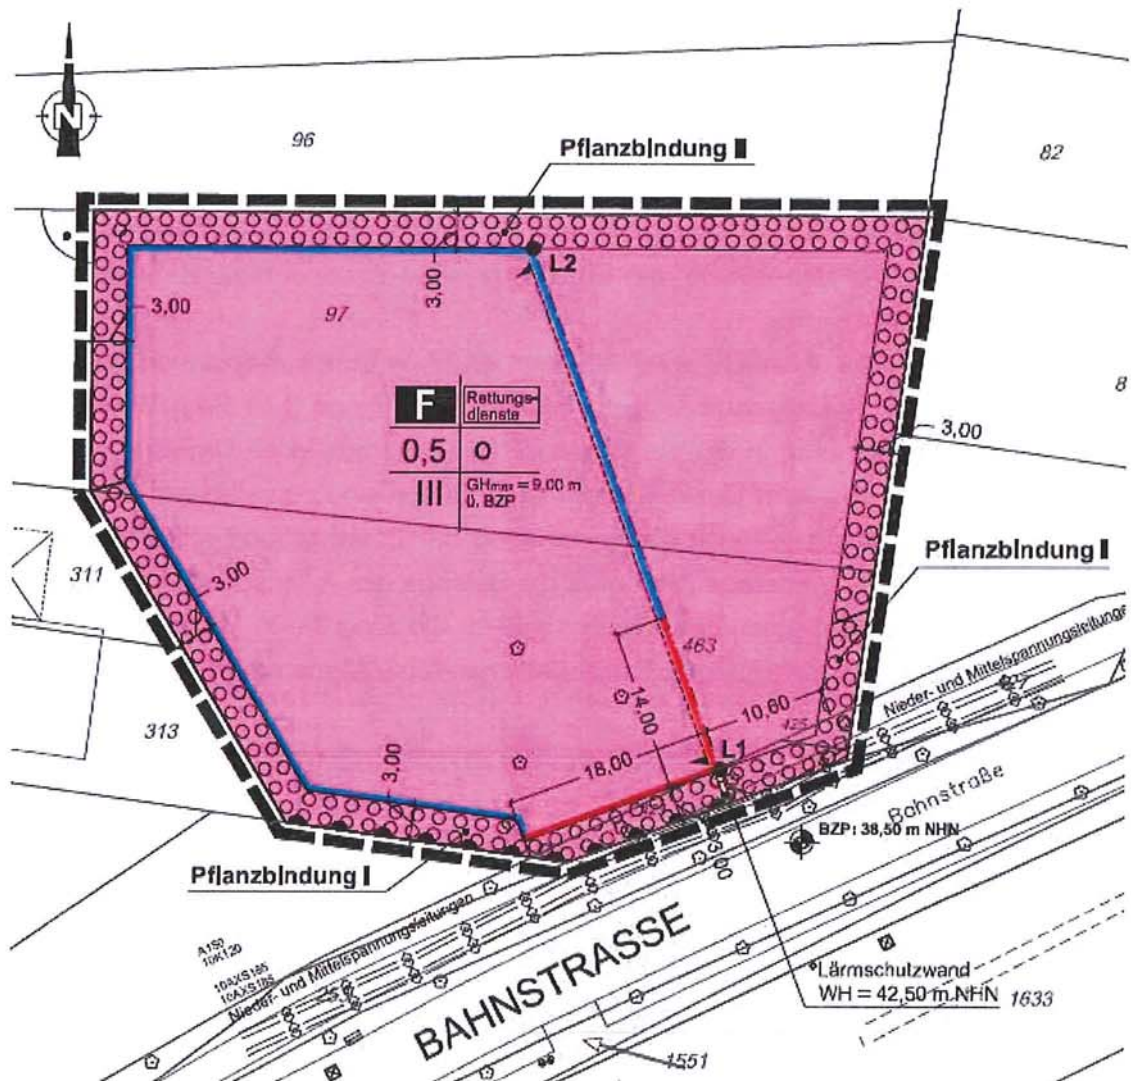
Bebauungsplan Nr. 535 „Nördlich der Bahnstraße“ (Stand 22. Mai 2018)
